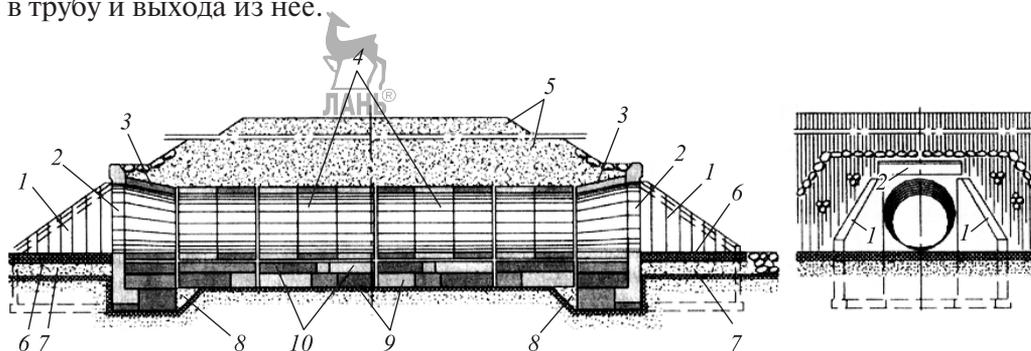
Конструкция типовой сборной железобетонной трубы:
